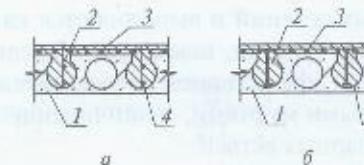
Усиление сборной многопустотной плиты перекрытия:
